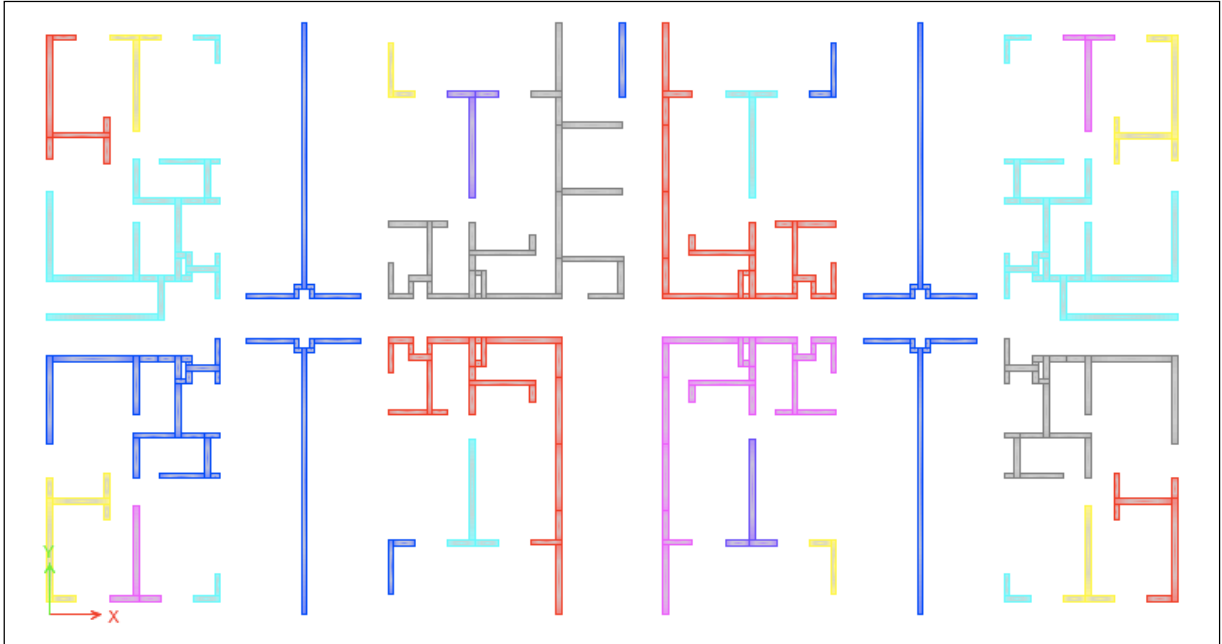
Vista en planta del Edificio G (elementos tipo barra de sección transversal irregular)
